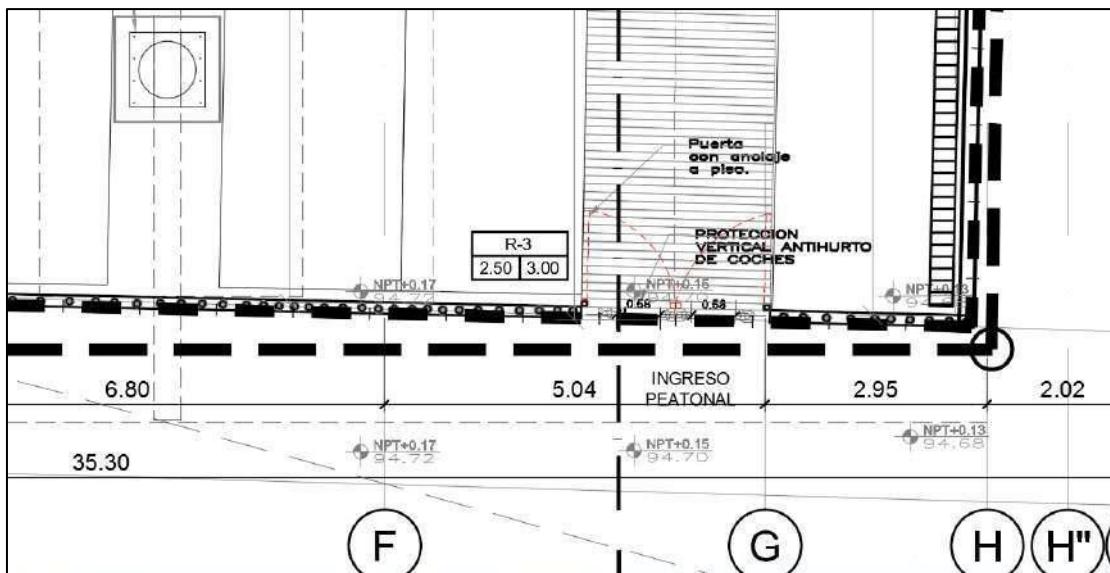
Plano Arquitectura con niveles Topográficos – Ingreso al Supermercado.
